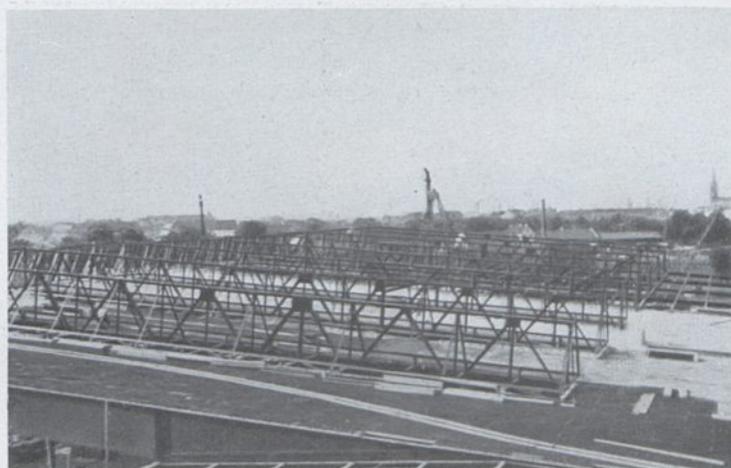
Blick auf das Hallendach mit Fachwerkbindern und Oberlichtkonstruktionen.
